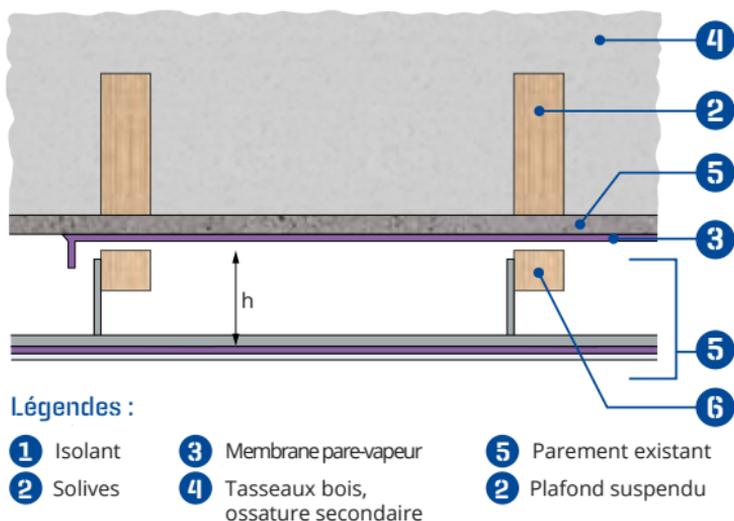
Membrane sur la plaque de plâtre d'un plafond suspendu
